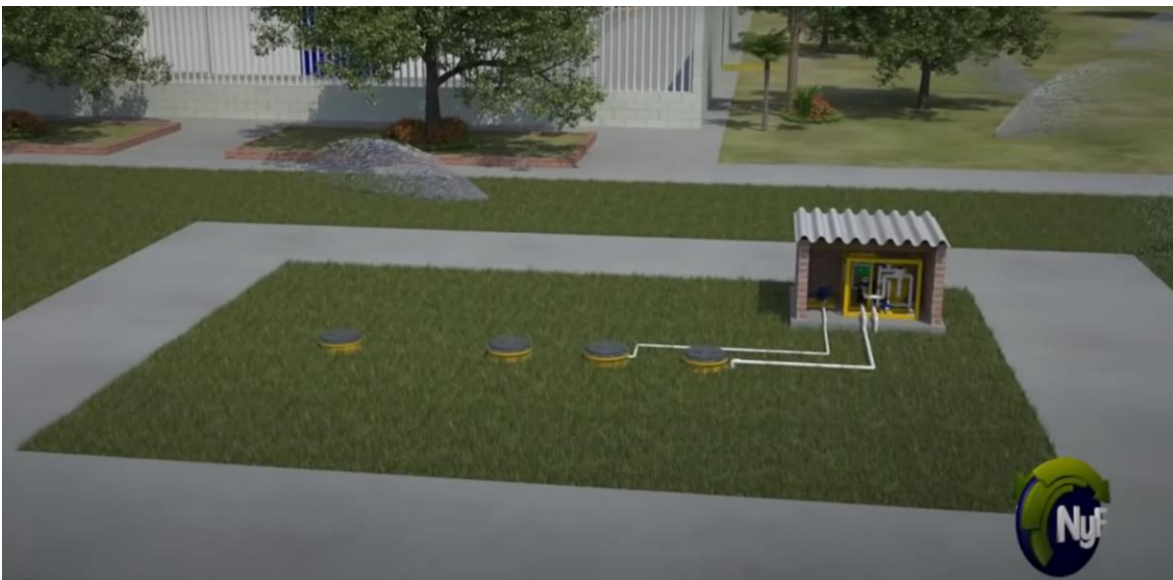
Vista de la planta PTAR y del Módulo de Perfeccionamiento de Agua
